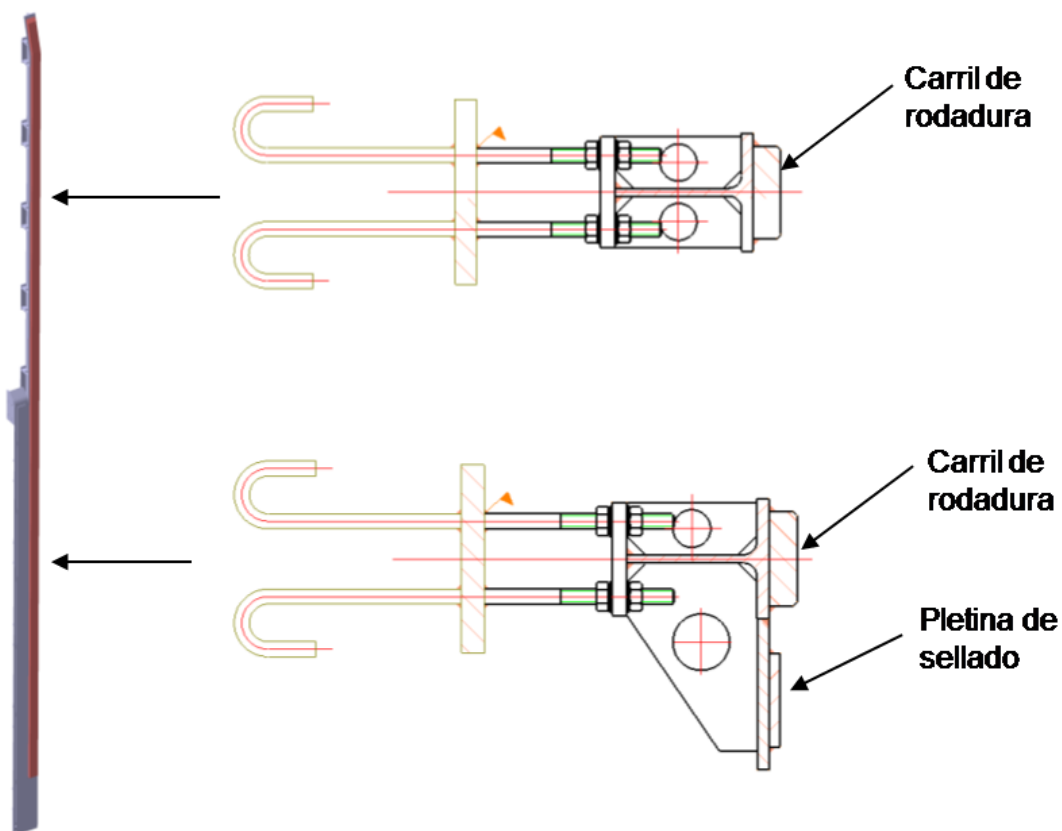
Detalle de Ubicación de las placas para los hierros fijos compuerta mural
